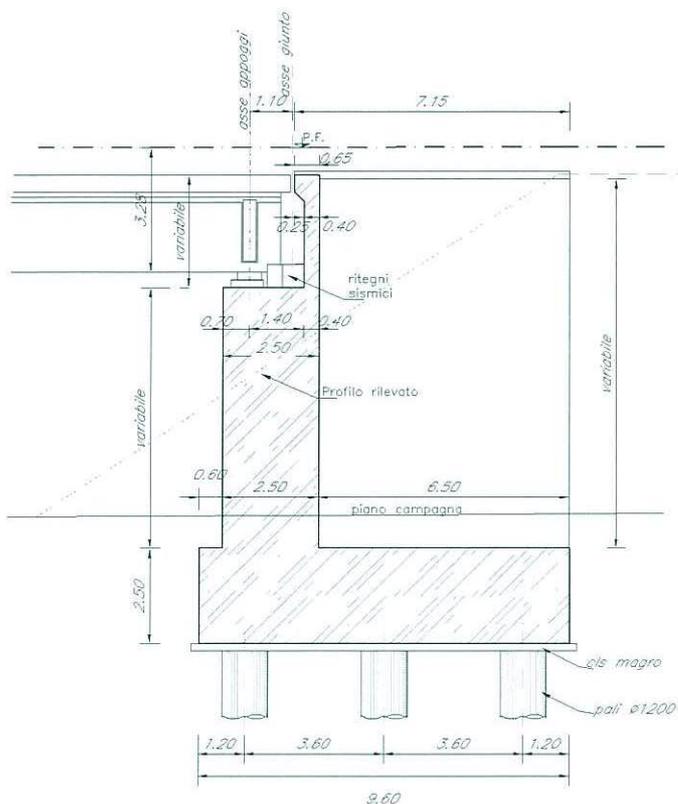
Sezione longitudinale della spalla tipo.
